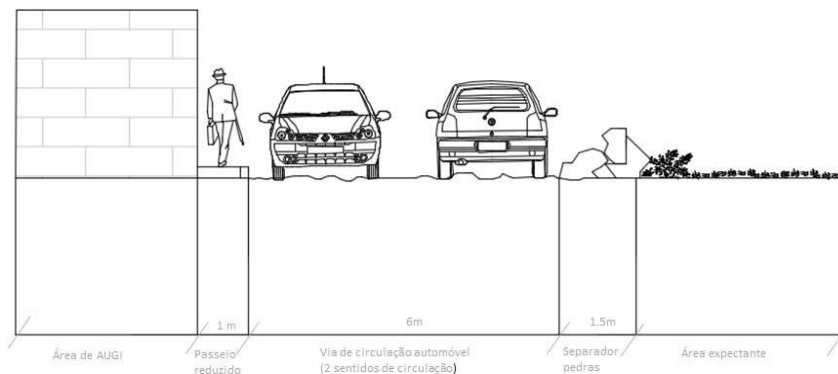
Perfil com situação actual tipo Travessa de Antevila
